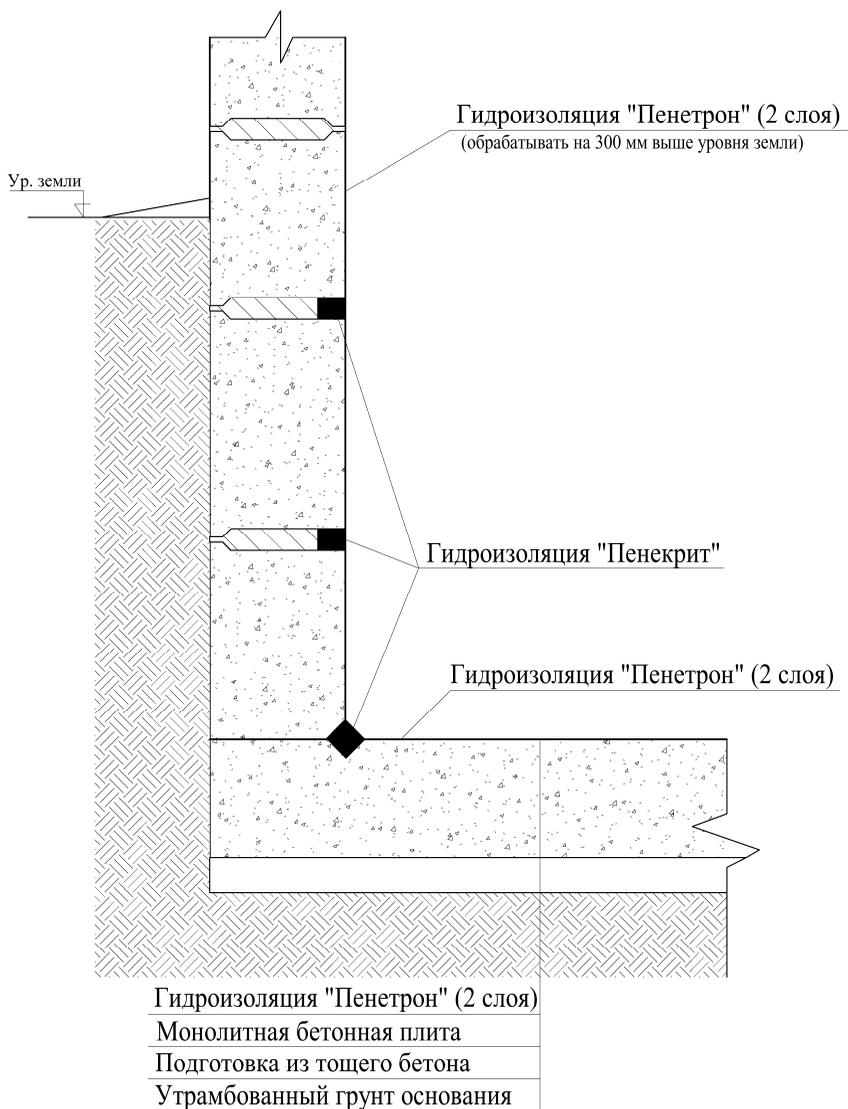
Б. Гидроизоляция конструкции из бетонных блоков
